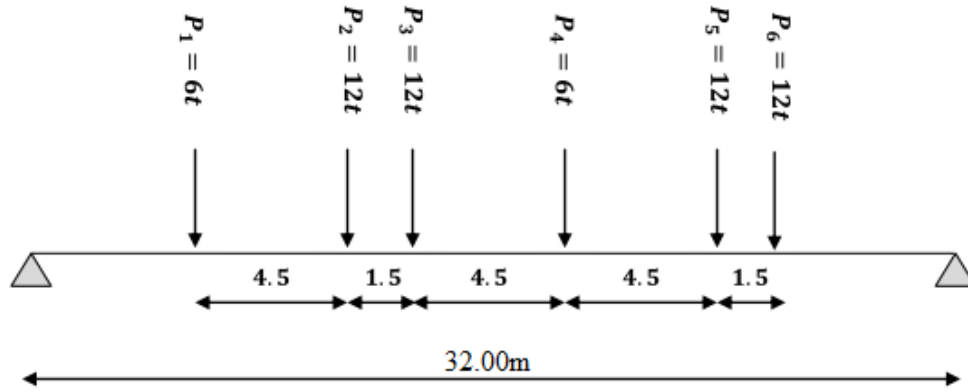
Système Bc ; disposition de deux camions sur la chaussée (sens longitudinal).
